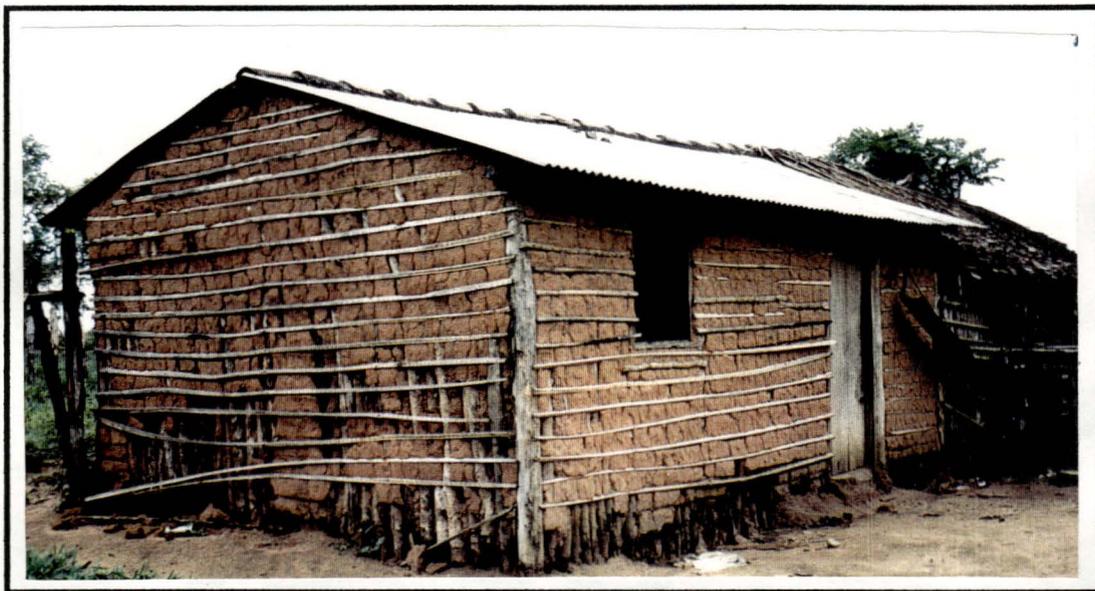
Habitação de taipa de sopapo ou taipa de sapé.
